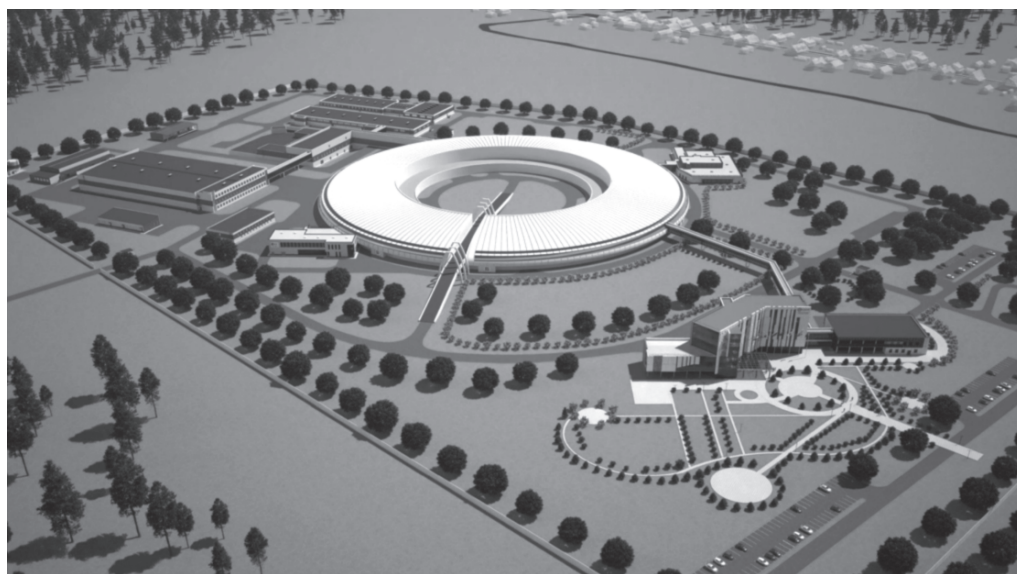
Общий вид ЦКП “СКИФ”. На переднем плане административный корпус и столовая.
